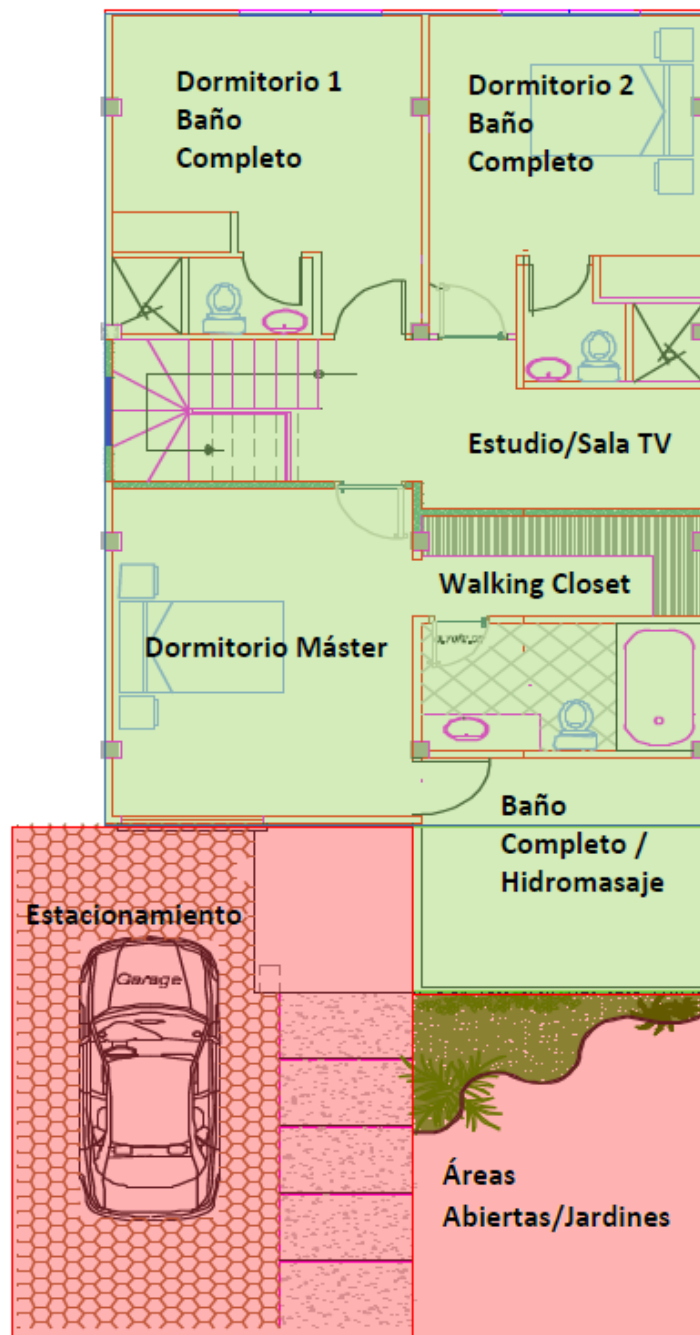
5 Planta Alta Vivienda Tipo No. 2
